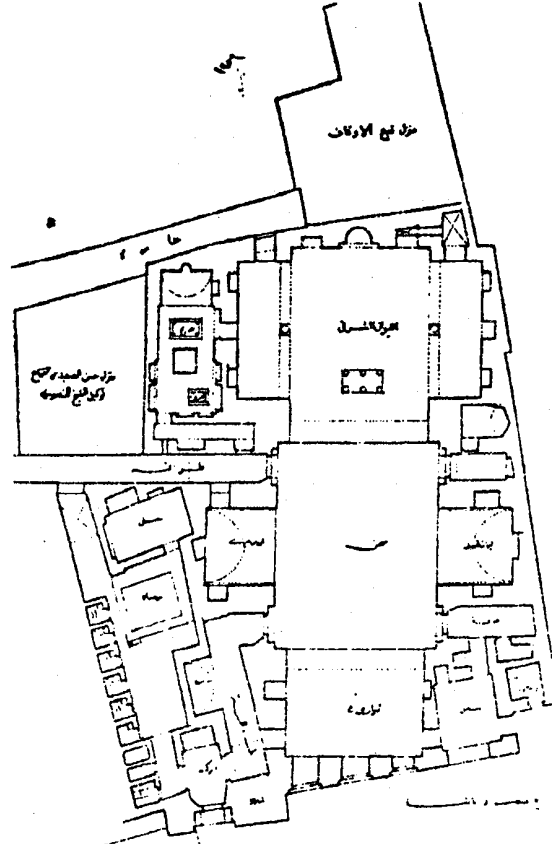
مسقط أفقي لمدرسة الجاي اليوسفي بالقاهرة
